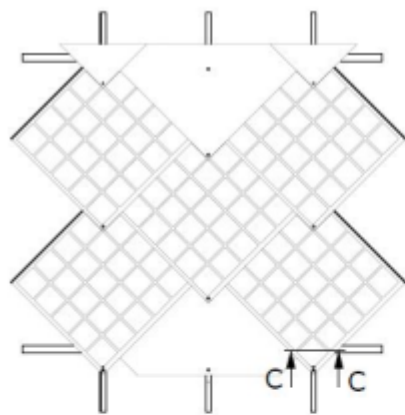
Vue de dessus et de côté des lattes à profil ouvert
